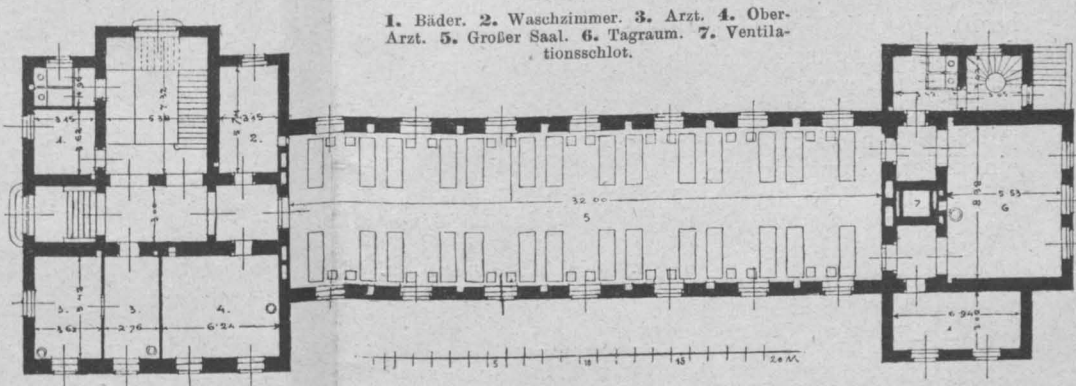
St. Stefans-Spital in Budapest. Grundriss des Pavillons für interne Kranke.
